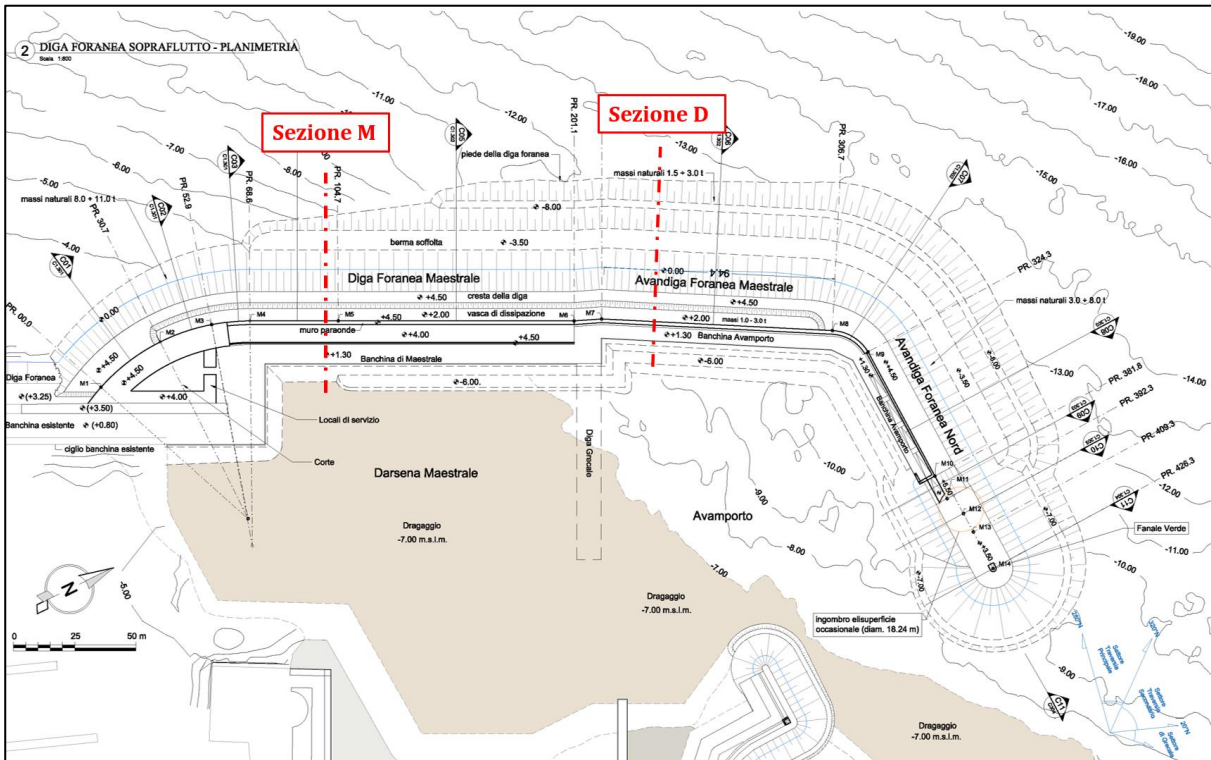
Planimetria di progetto del nuovo tratto di diga del Porto di Punta Ala. In rosso localizzazione delle sezioni di studio - Fonte: MODIMAR
